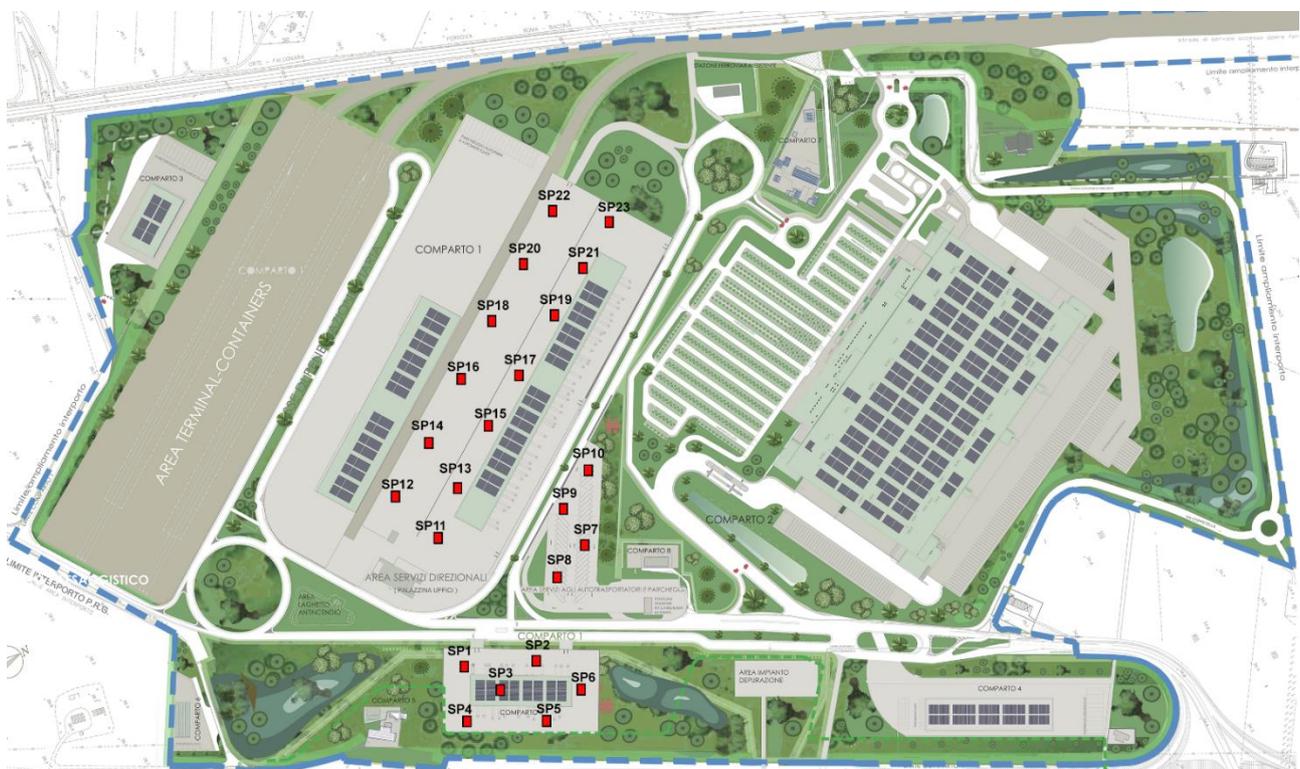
Planimetria con l'ubicazione dei campionamenti nel comparto 1
